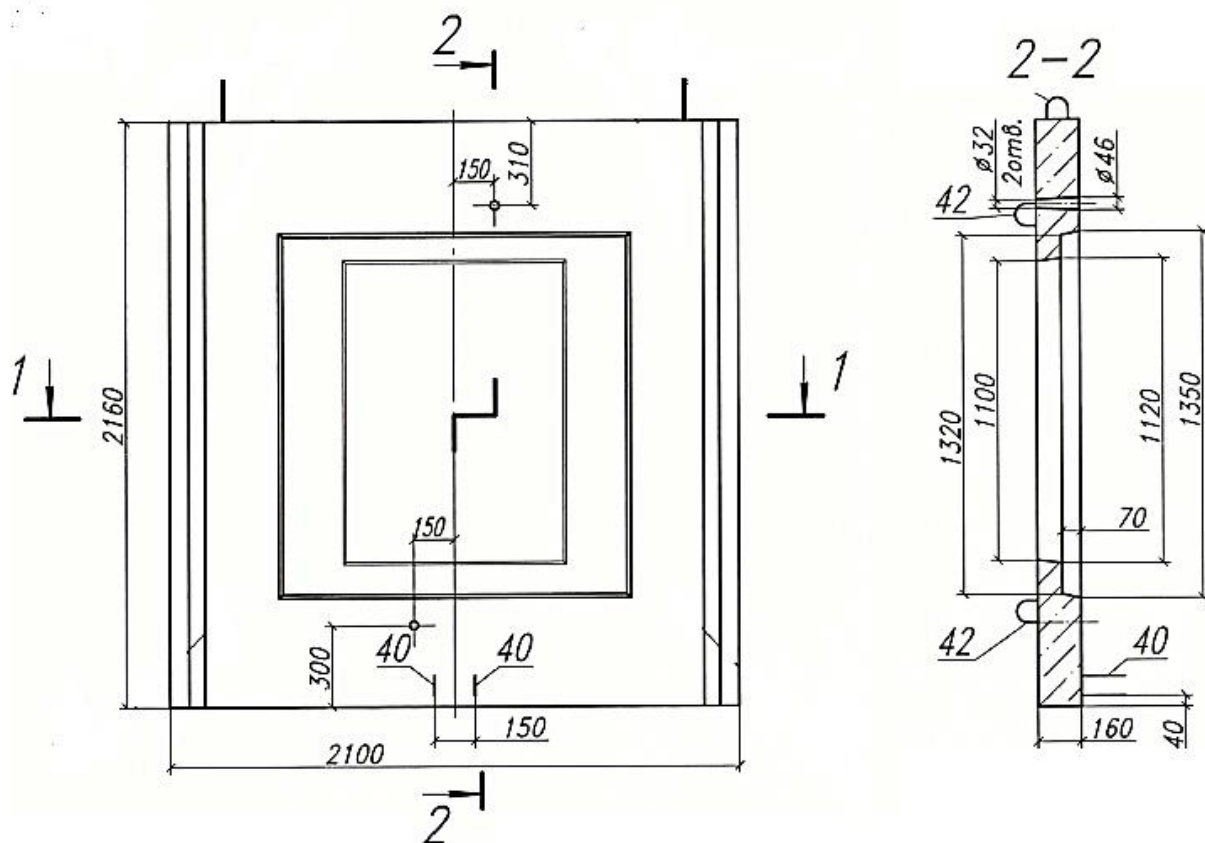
Размеры блока «СБ-3»: габаритные размеры;
